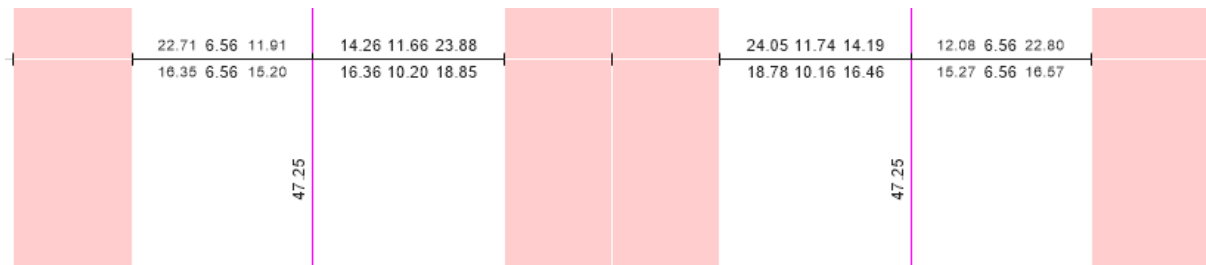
Acero Requerido por momentos en Vigas 4° Piso
